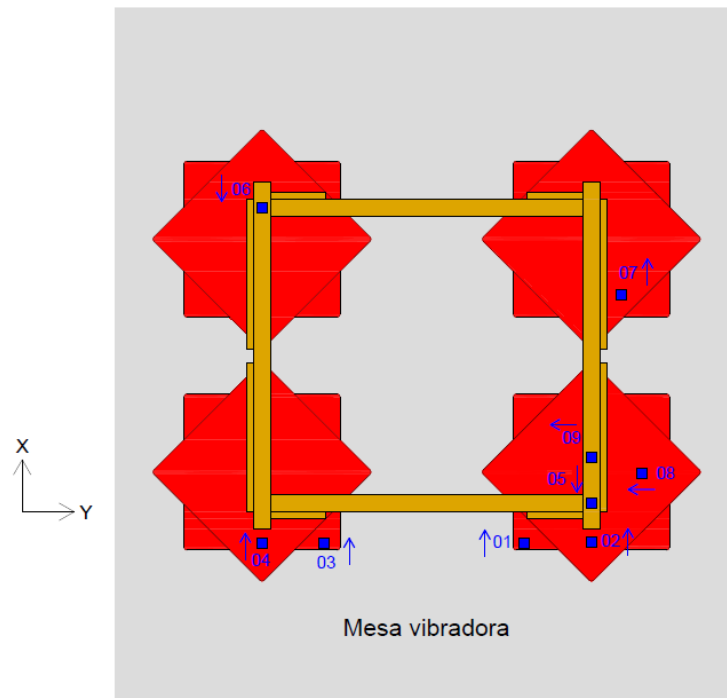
Croquis de vista en planta de estructura aislada instrumentada en mesa vibradora, plano XY.
